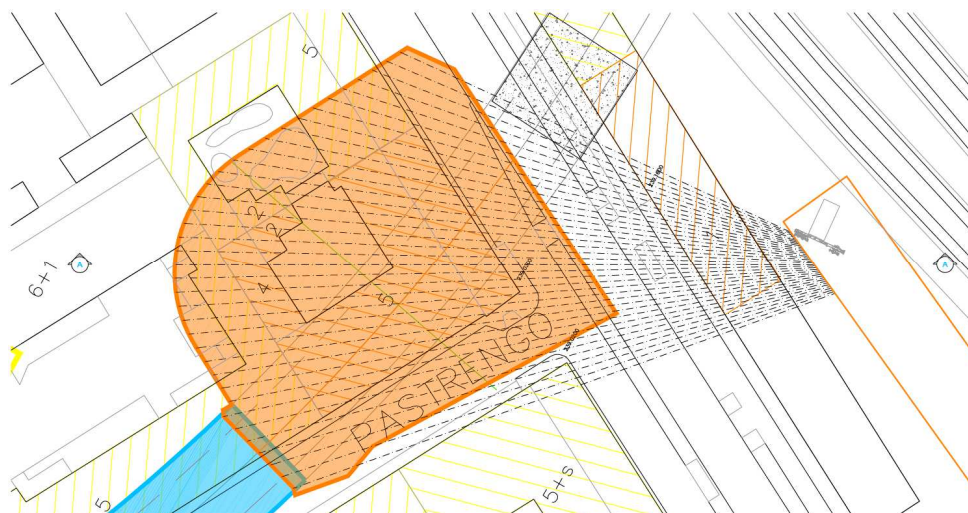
Schema tipologico relativo al consolidamento tipo C12: vista in pianta.
